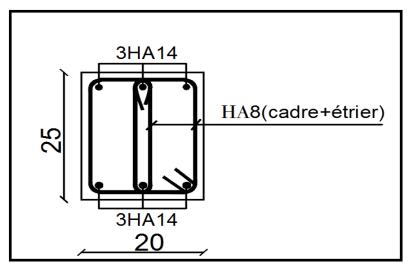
Ferraillage en travée d'une poutre de chainage
